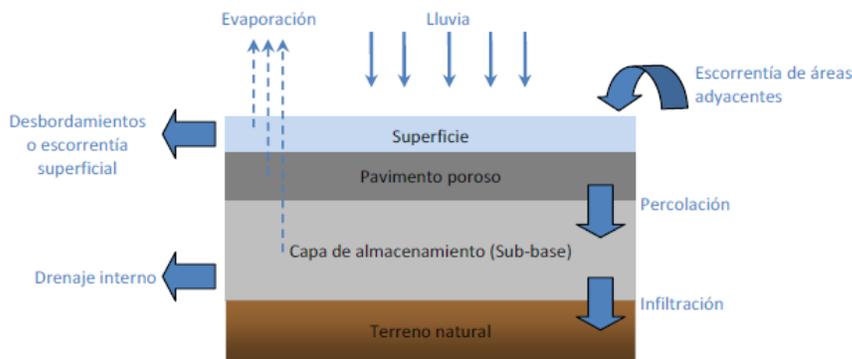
Estructura de un pavimento permeable (García Haba, 2012).
